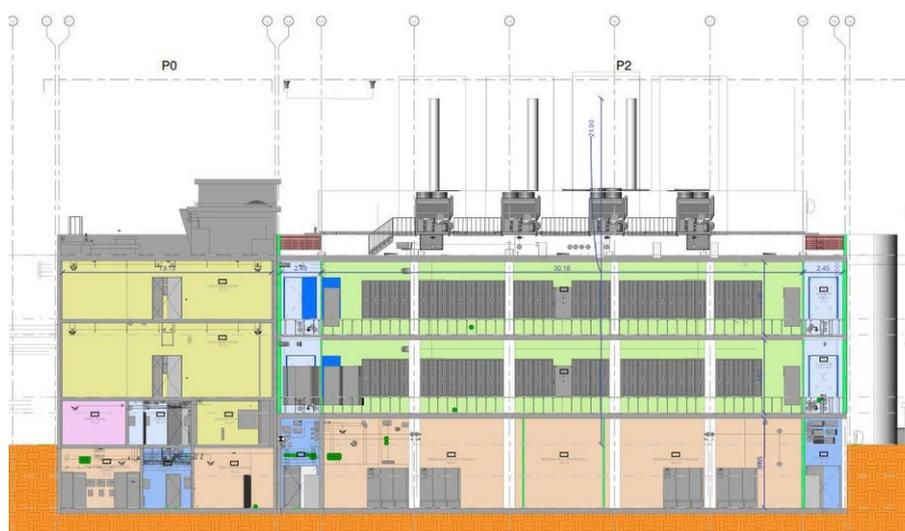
Coupe transversale du projet de construction ds bâtiments P0 et P2 - (Annexe n°2 p.51).
